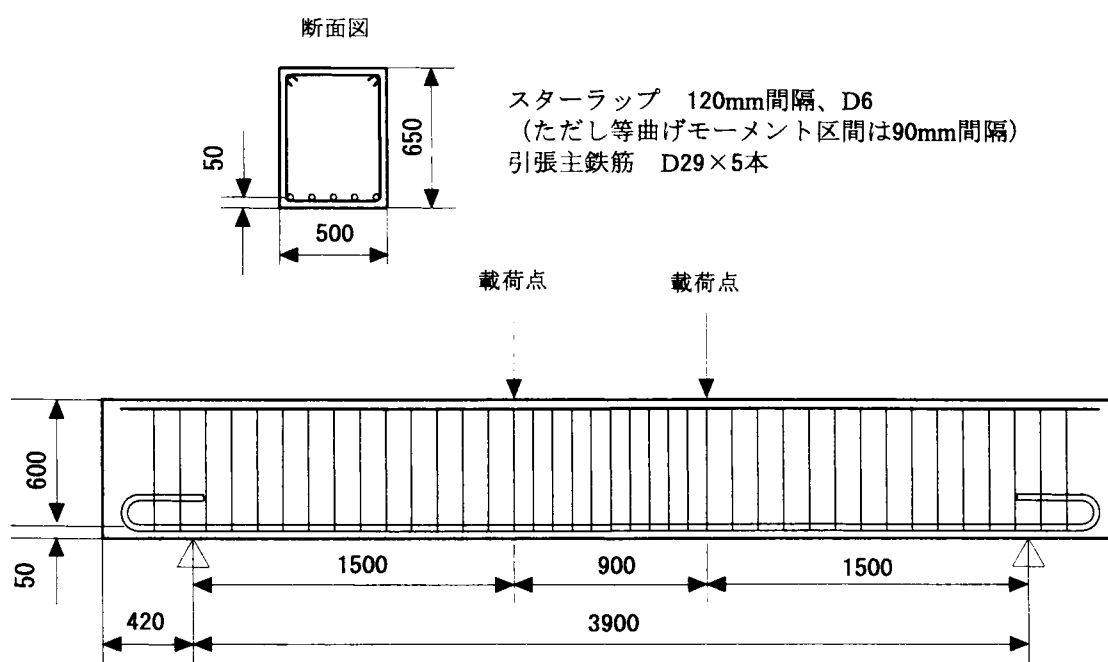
鉄筋コンクリート供試体の寸法・配筋図（単位：mm）
